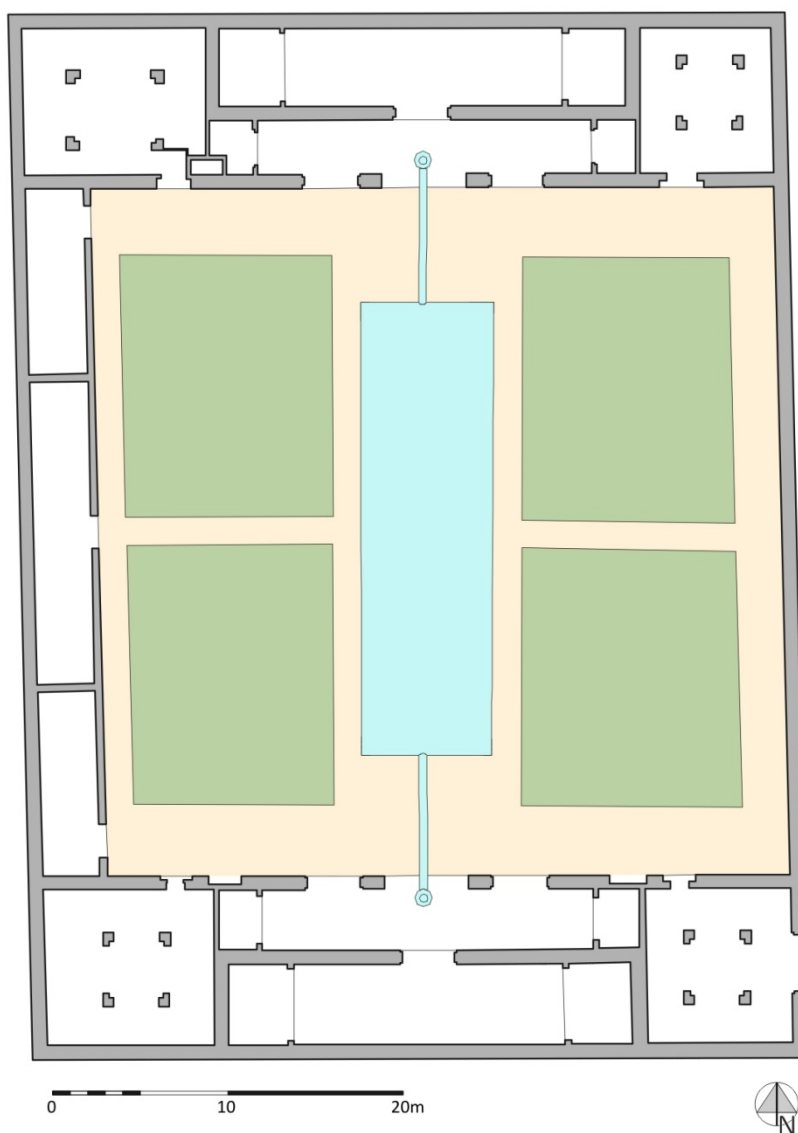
El Alcázar Seguir. Planta (Pozo, 1999; Pozo, Robles y Navarro, 2007b)
